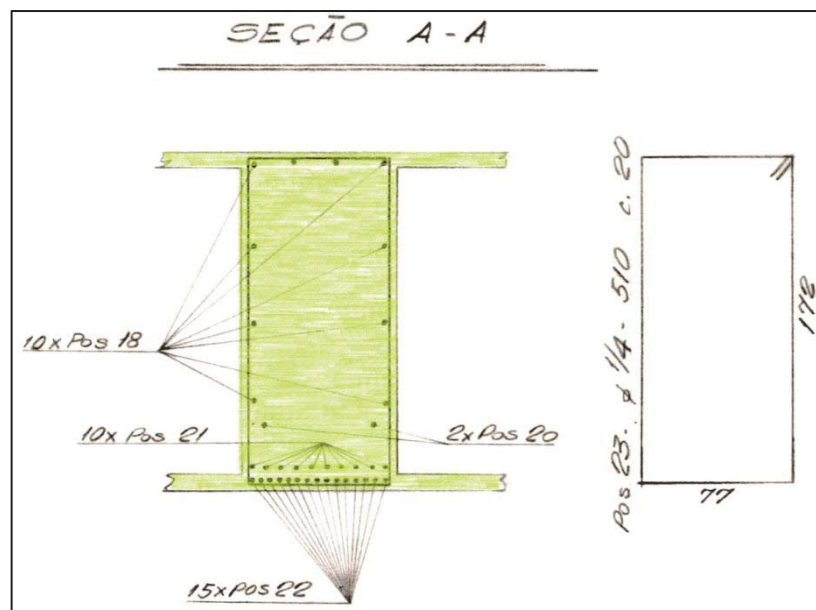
Detalhe de armação de viga (fonte ArPDF)
